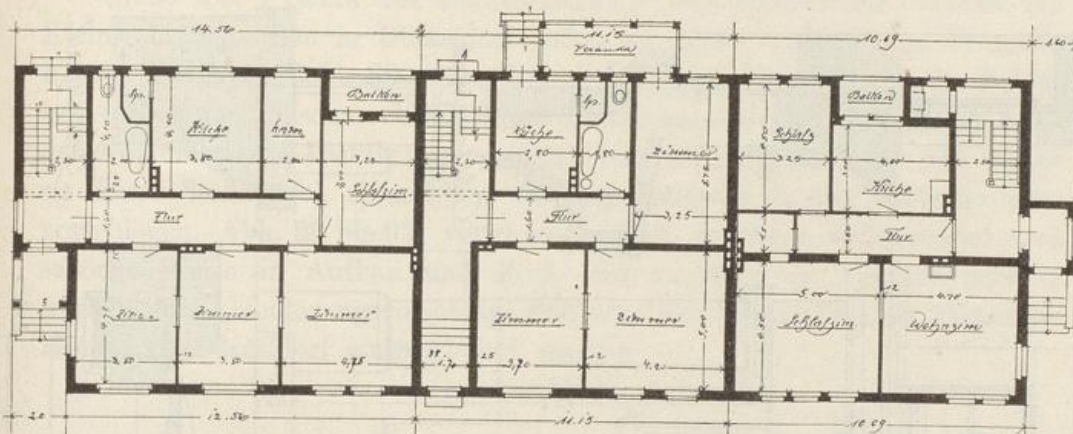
Grundrisse zu einer Gruppe von Mietshäusern.
